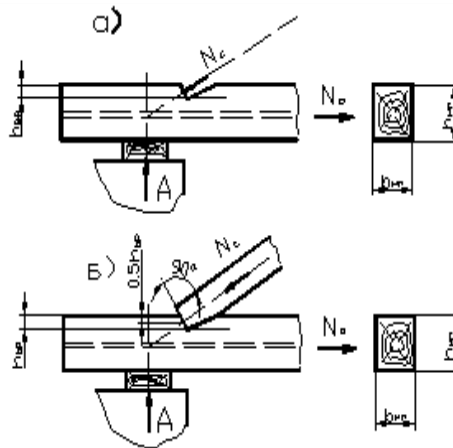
Конструювання врубок з одним зубом: *а* - центрування, *б* - розмітка.
